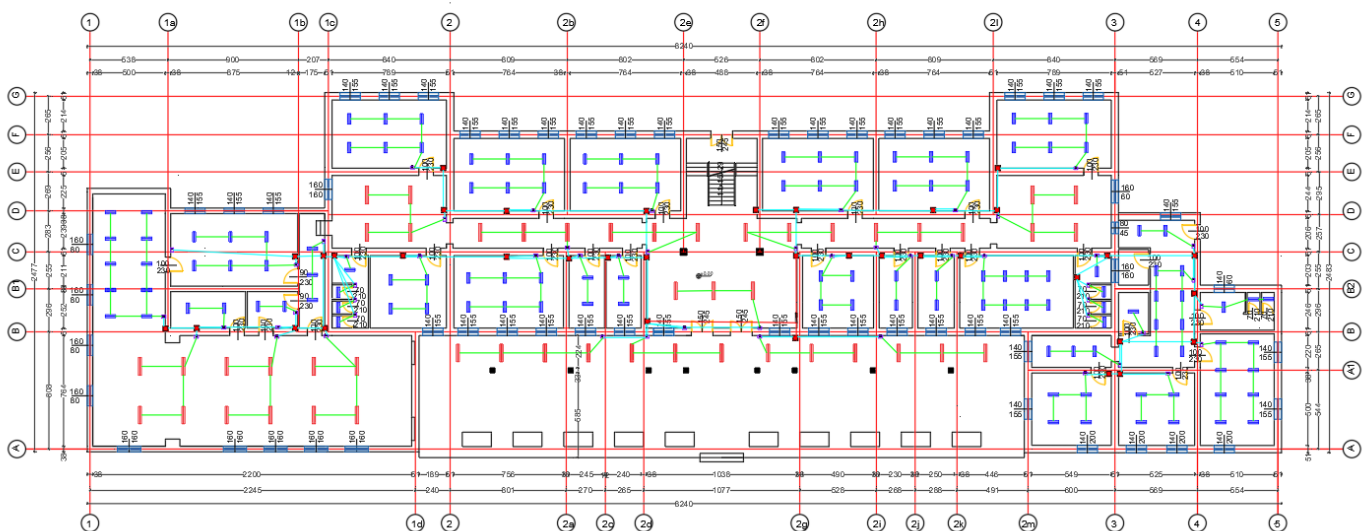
Planimetria e instalimeve elektrike, kati perdhe
